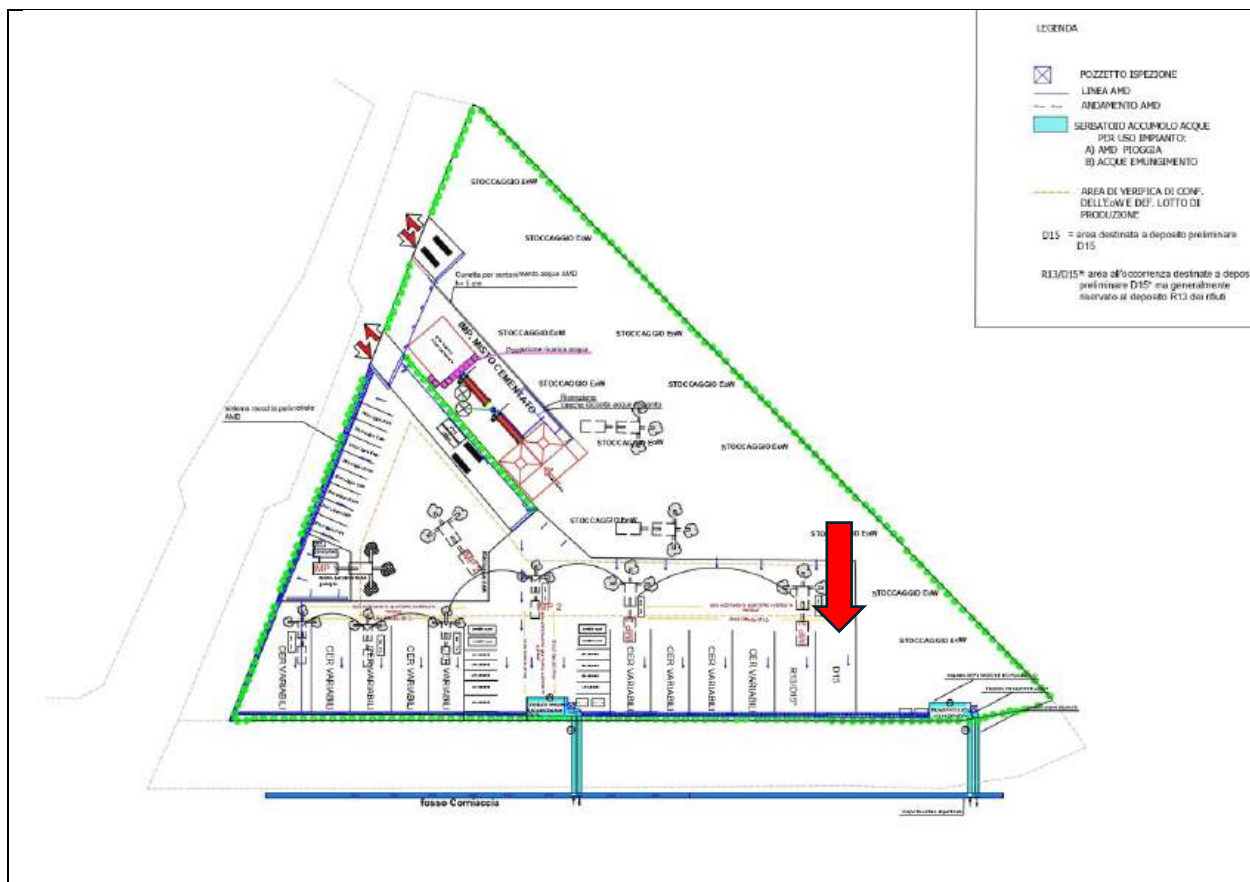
Planimetria con all'interno l'area dedicata alla verifica di conferimento degli EoW e al deposito preliminare D15.
